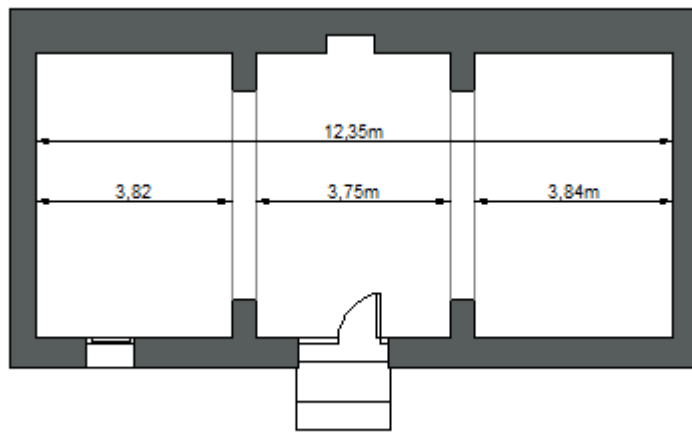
Planta de la Ermita de Sant Antoni de Xàtiva
